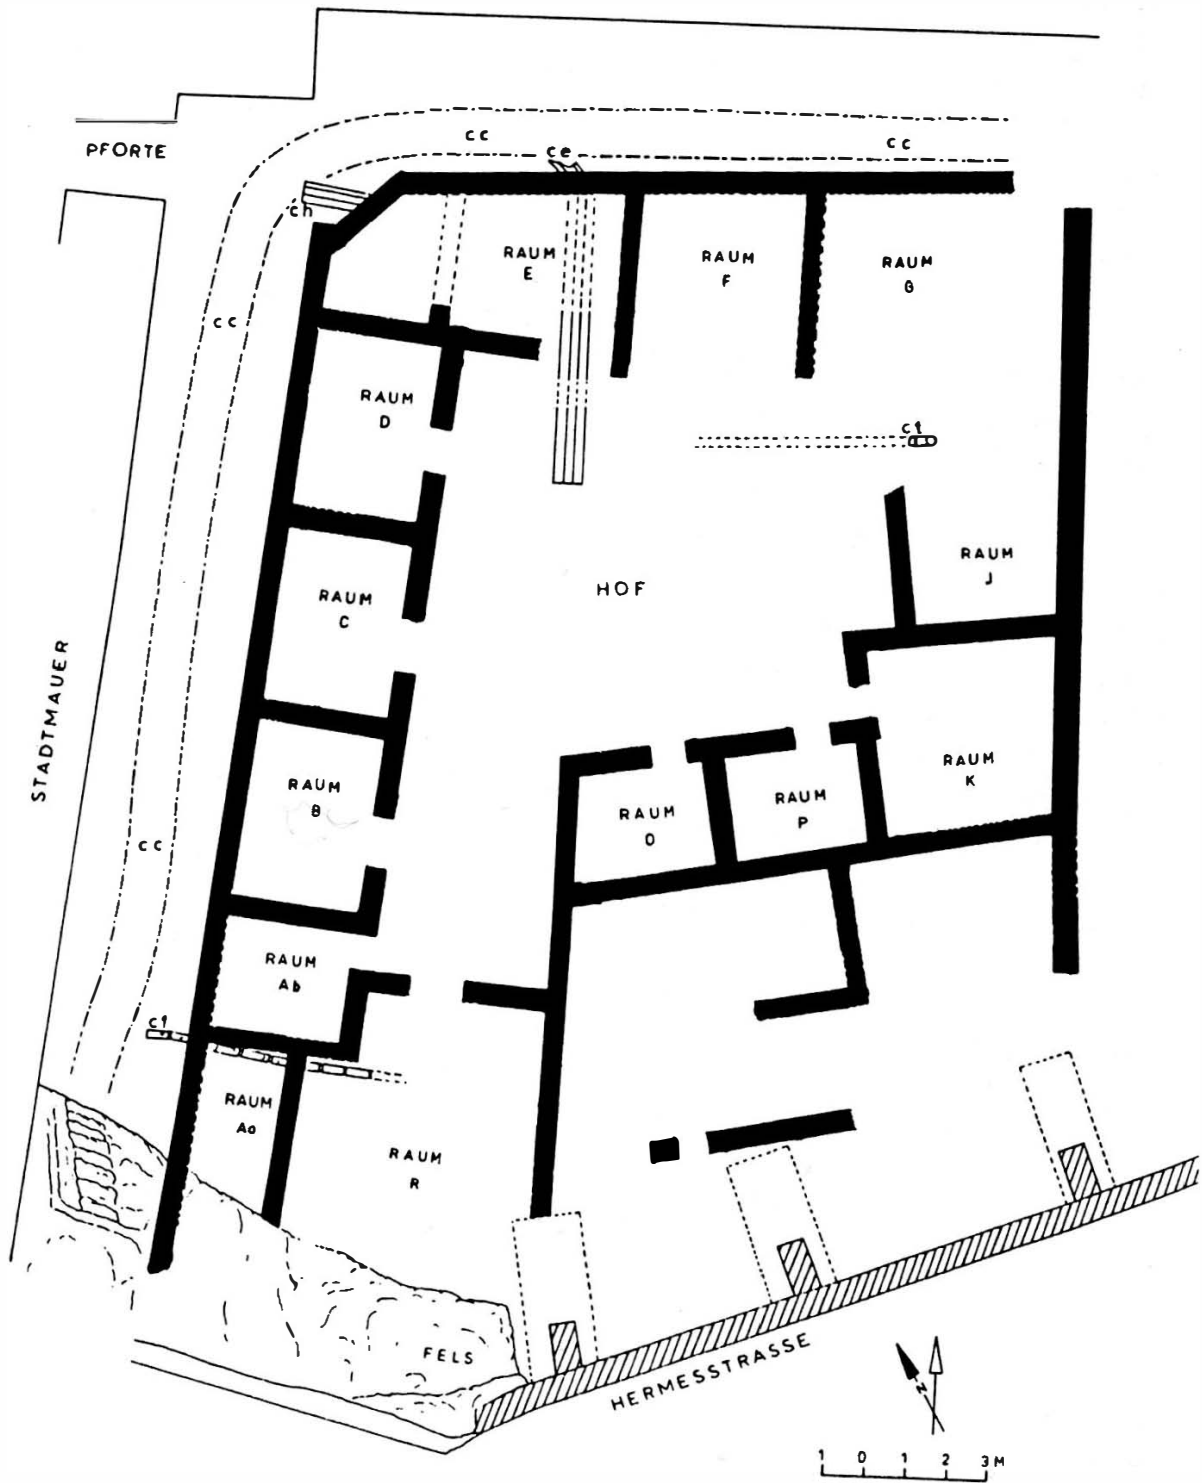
Grundriss des Baues Z 2 (aus: U. Knigge, AA 1981, 390)
